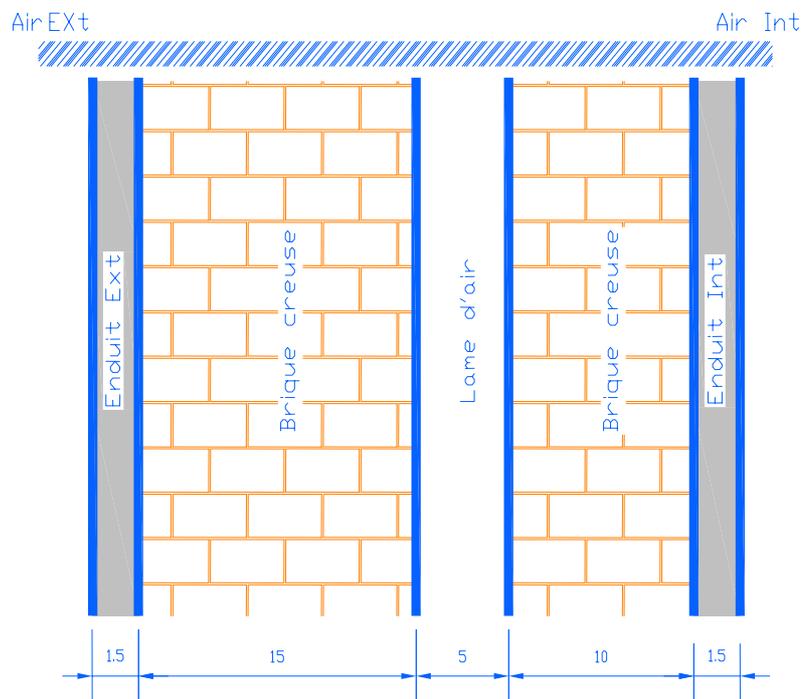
Section d'un mur extérieur d'un logement F3 ou F4 en Algérie
